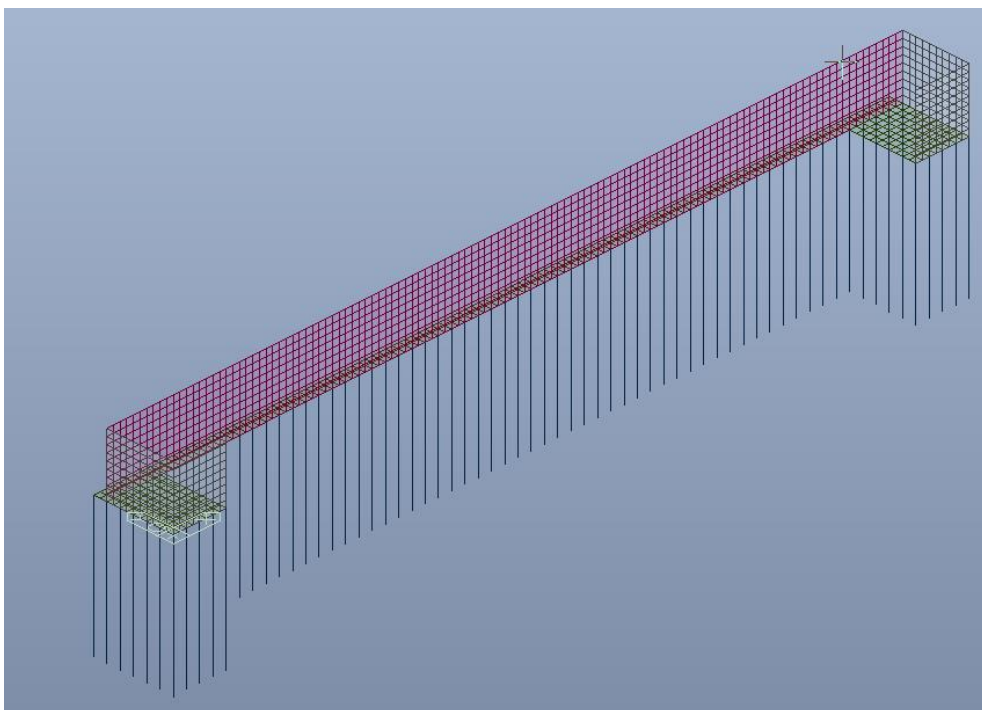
Vista planimetrica Modello FEM dell'opera di protezione.
